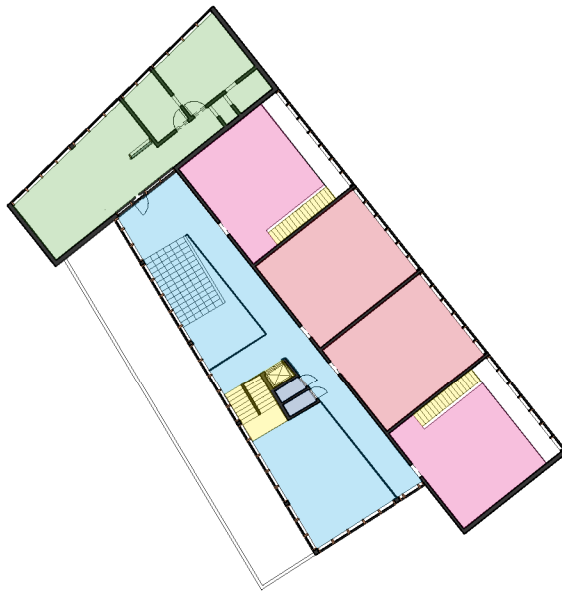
Funktionsschema Grundriss Obergeschoss 1:500
